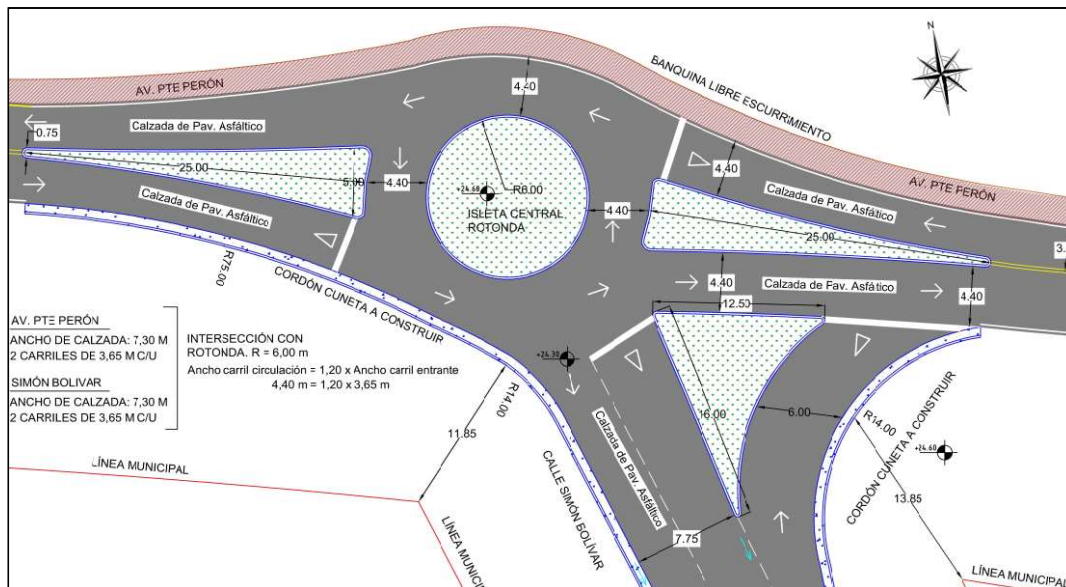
Rotonda proyectada Av. Pte. Perón y calle Simón Bolívar.
